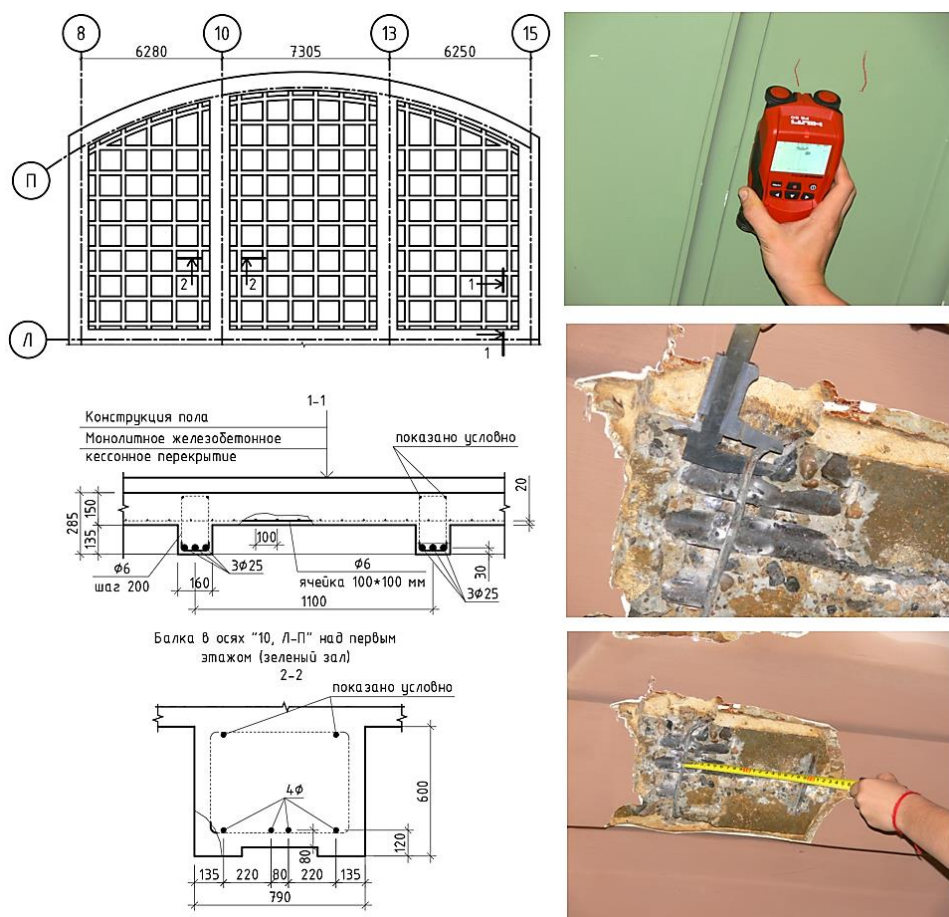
Определение конструкции перекрытия над залом первого этажа
